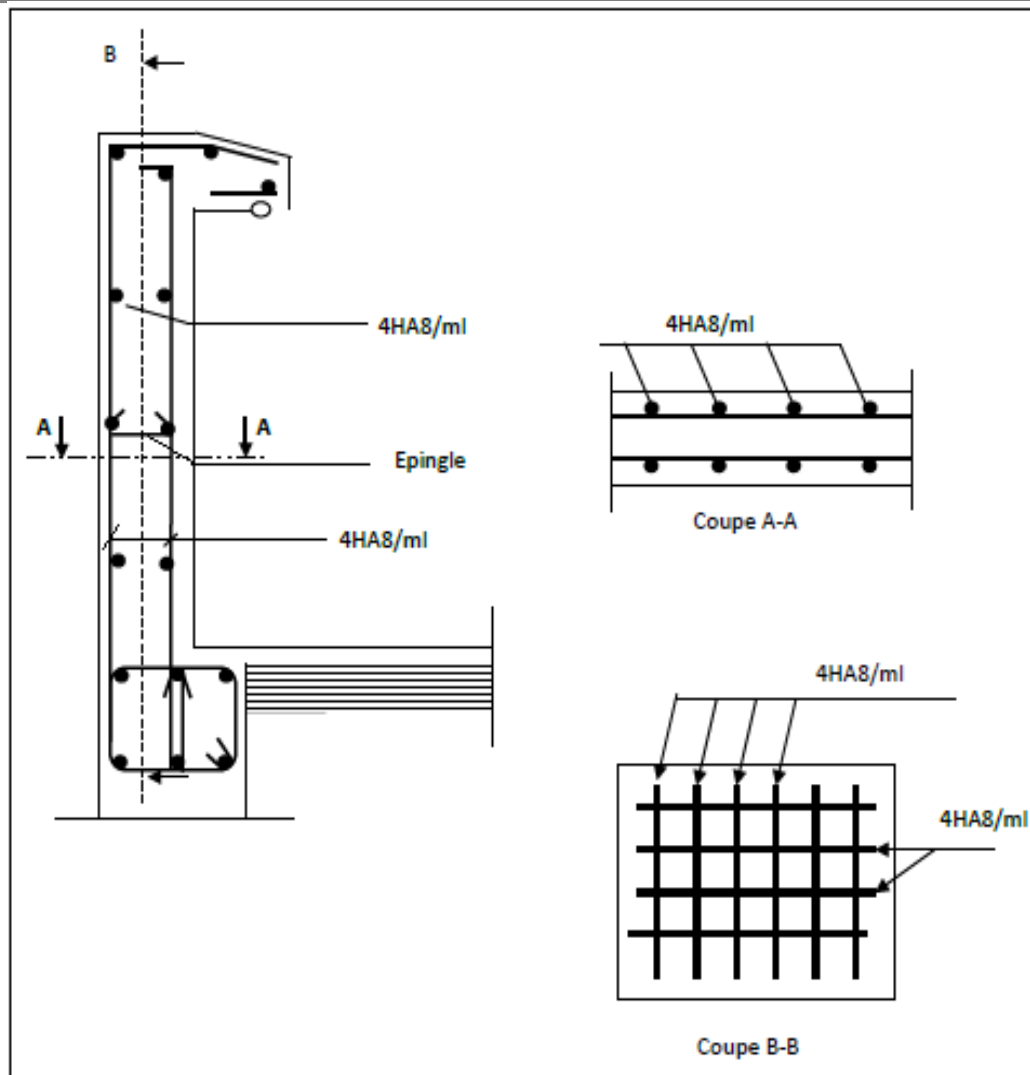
Plan de ferrailage du l'acrotère.
